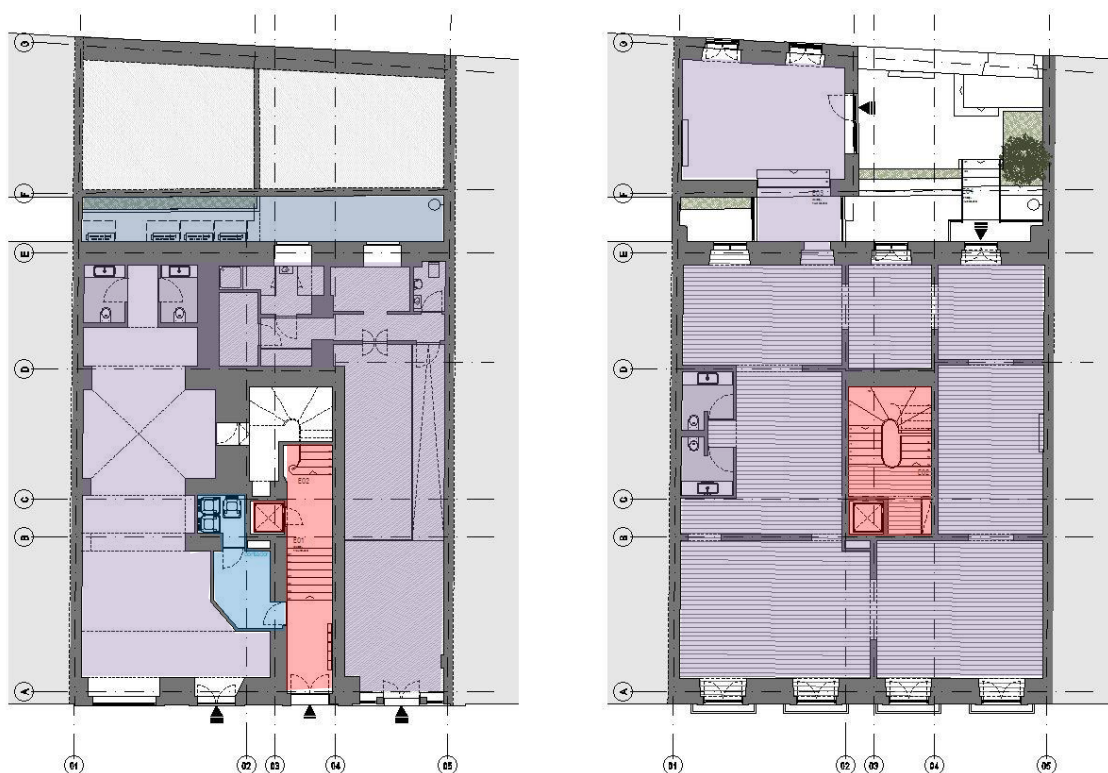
Planta Piso 00 e 01. (Saraiva &amp; Associados, 2017c).
